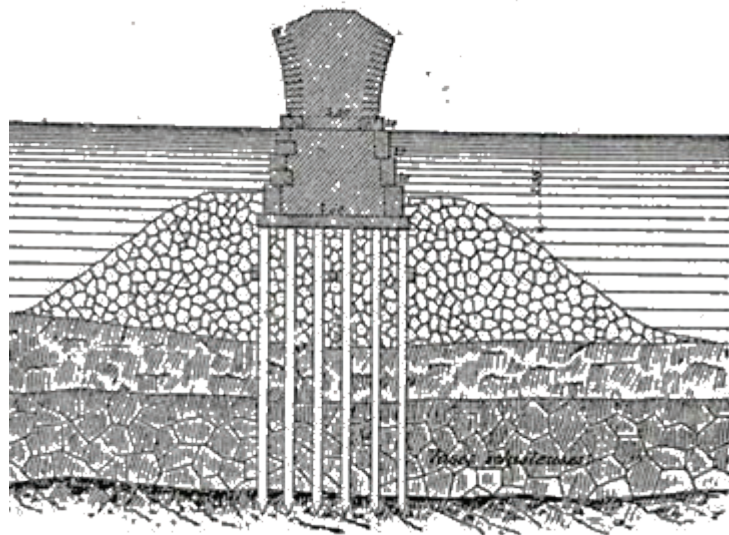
Fondations de ponts sur plateformes. (Pont de Tours sur la Loire).
